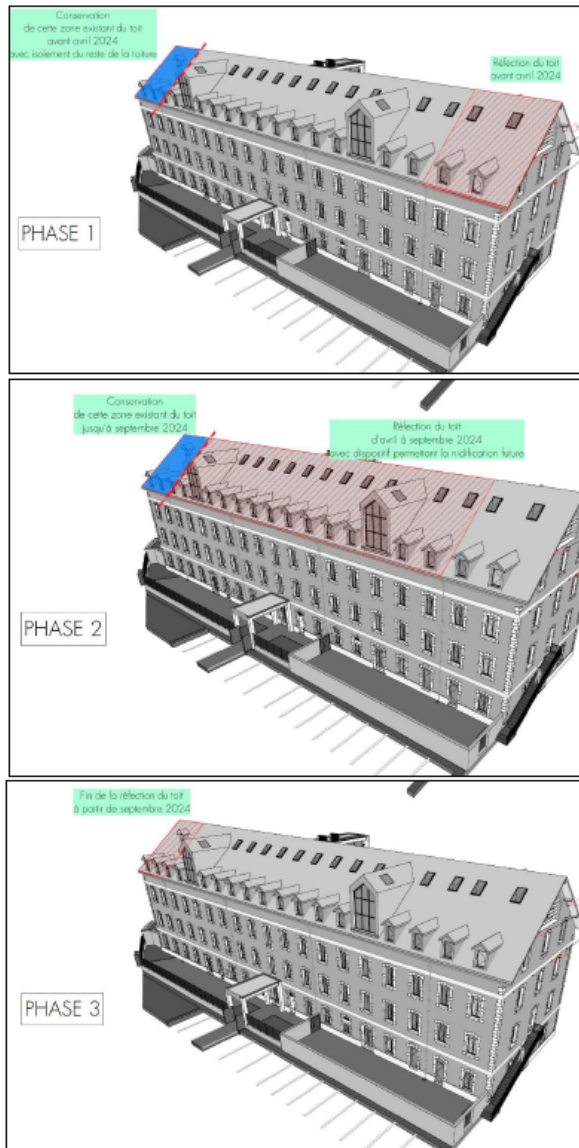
Bâtiment Collaud, Façade Nord-Est, C_NE_1
